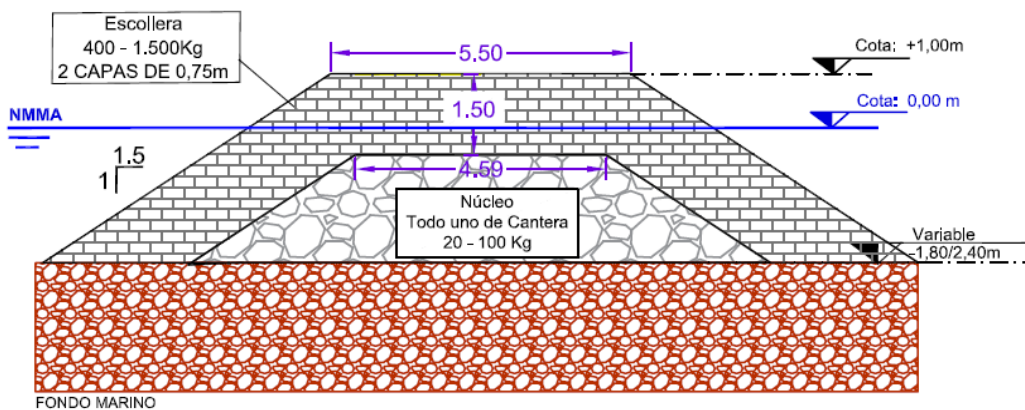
Sección de espigón coronado a 1,00 m sobre NMM
